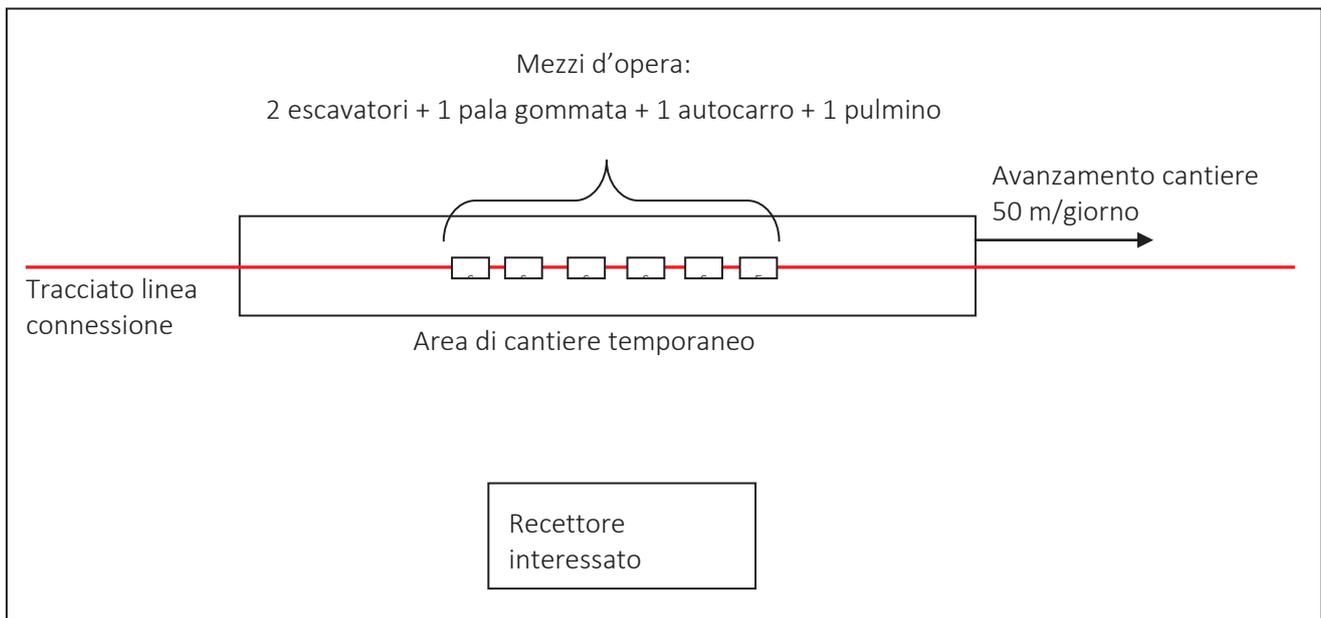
Rappresentazione schematica dell'area di cantiere durante le lavorazioni
